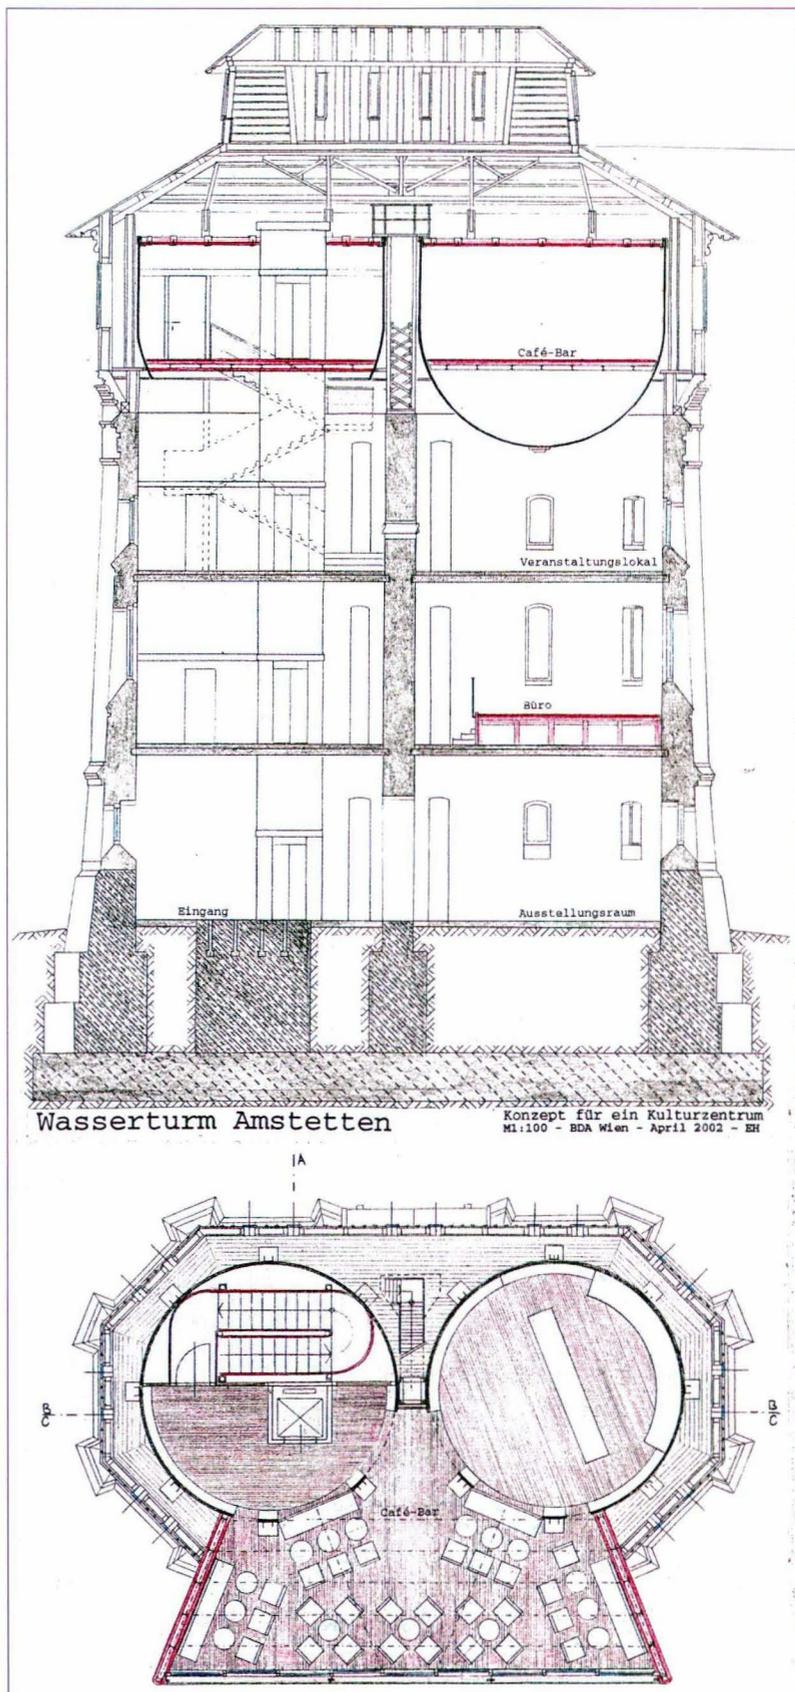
Amstetten, Wasserturm, Grundriss und Querschnitt
